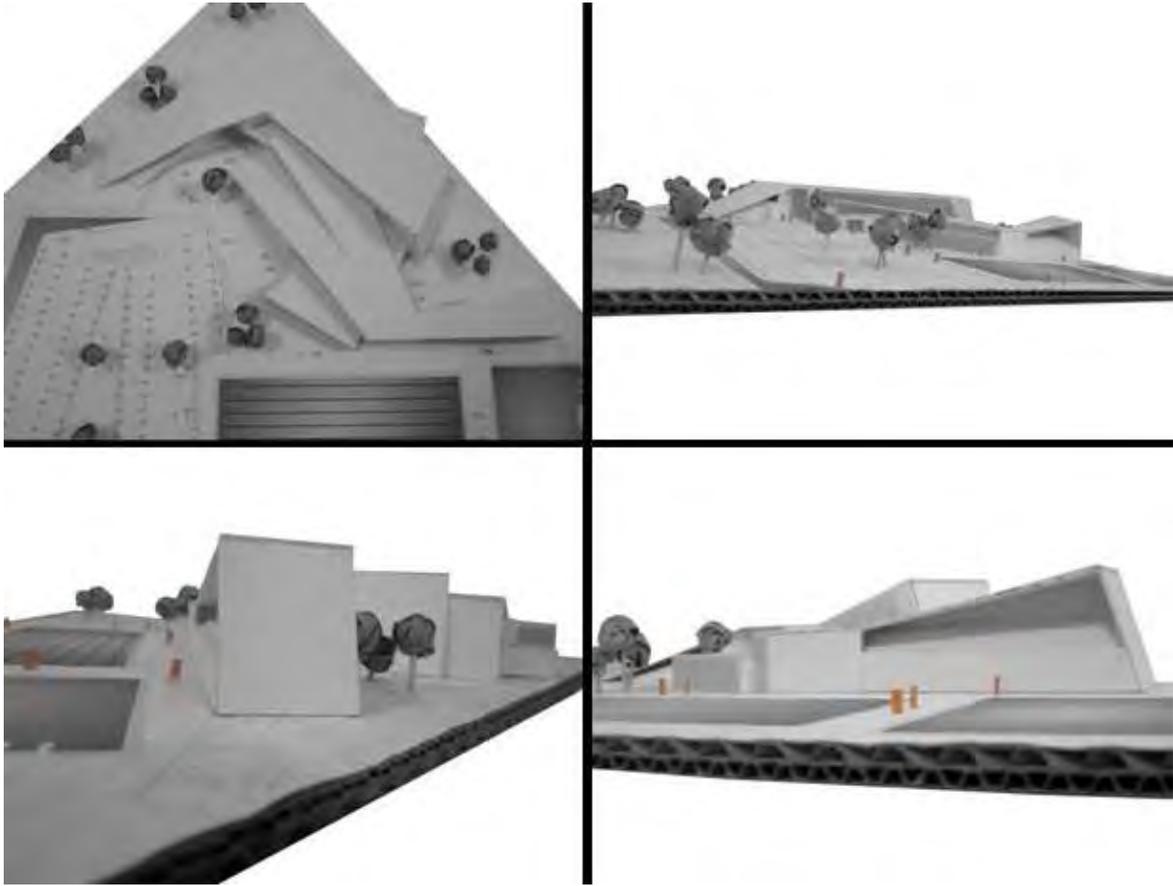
Maqueta volumétrica vistas planta y alzados.
